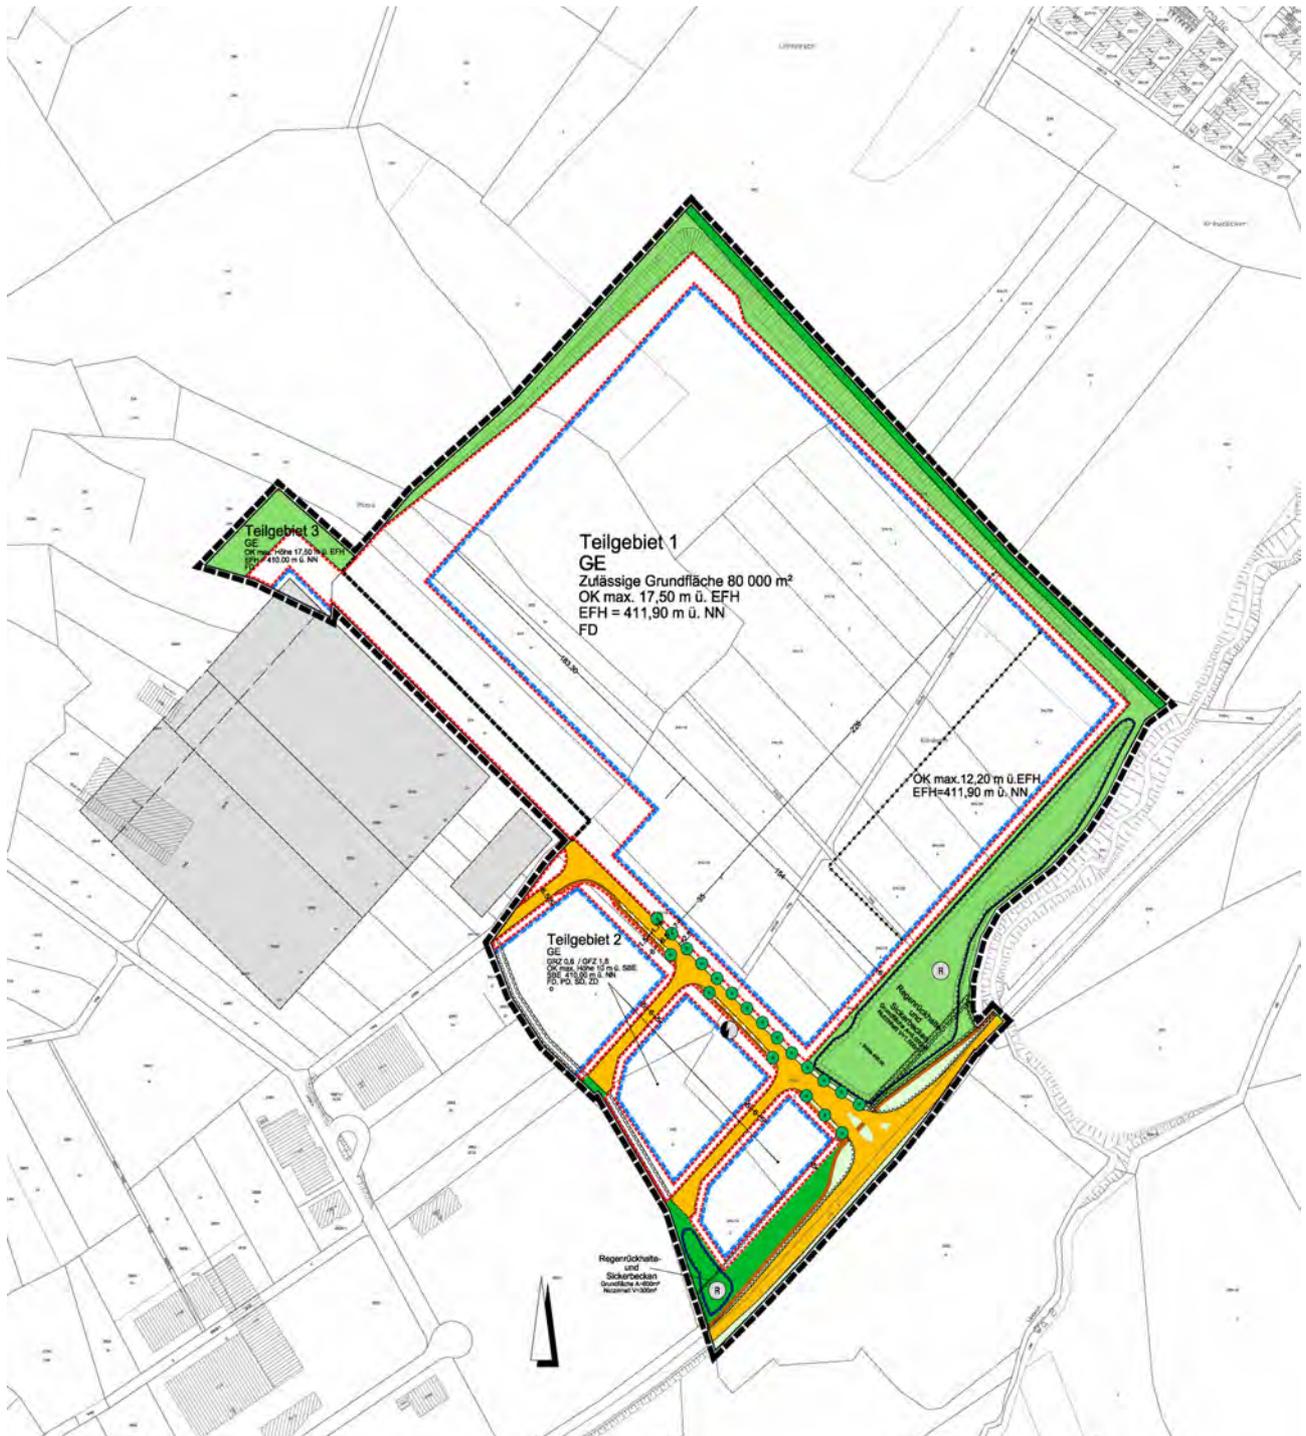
B-Plan Kluftern-Süd (Stadt Friedrichshafen)
